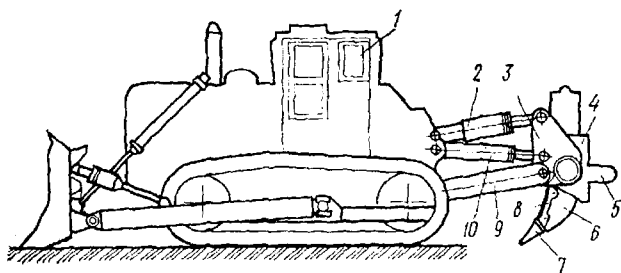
Общий вид рыхлителя: 1 – тягач; 2 – амортизатор; 3 – вертикальная стойка; 4 – рама; 5 – упор; 6 – зуб; 7 – наконечник; 8 – накладка; 9 – тяга; 10 – гидроцилиндр подъема рабочего оборудования
